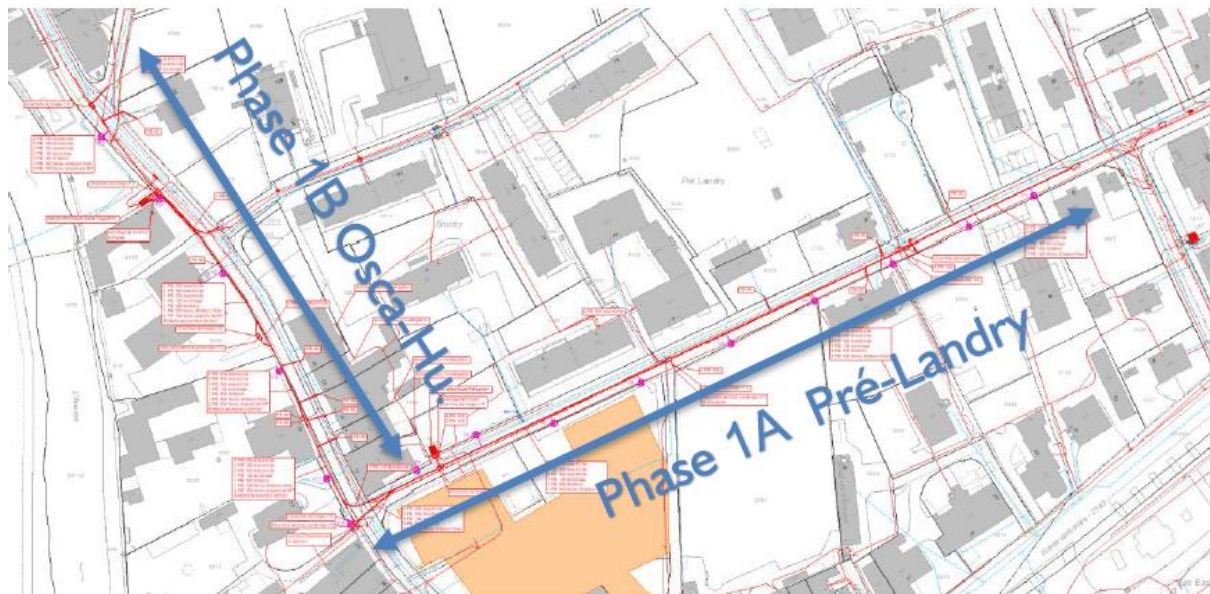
plan explicatif des travaux réalisés dans le cadre des travaux induits par le plan spécial
